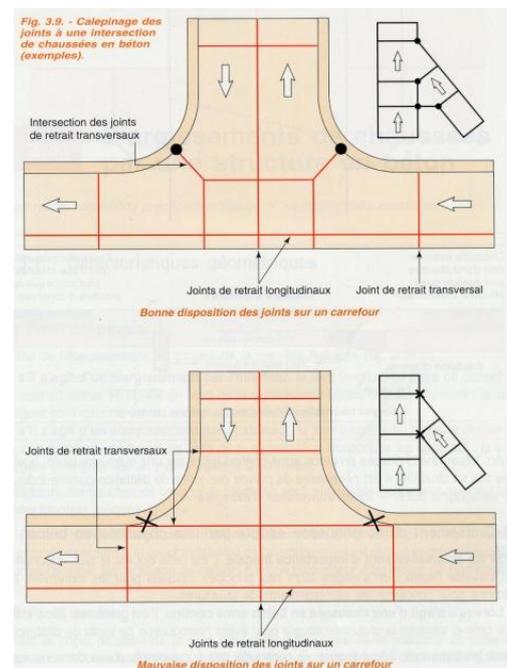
Exemple d'un calepinage des joints d'une insertion d'une chaussée en béton sur une autre chaussée en béton ; extrait de (5).
